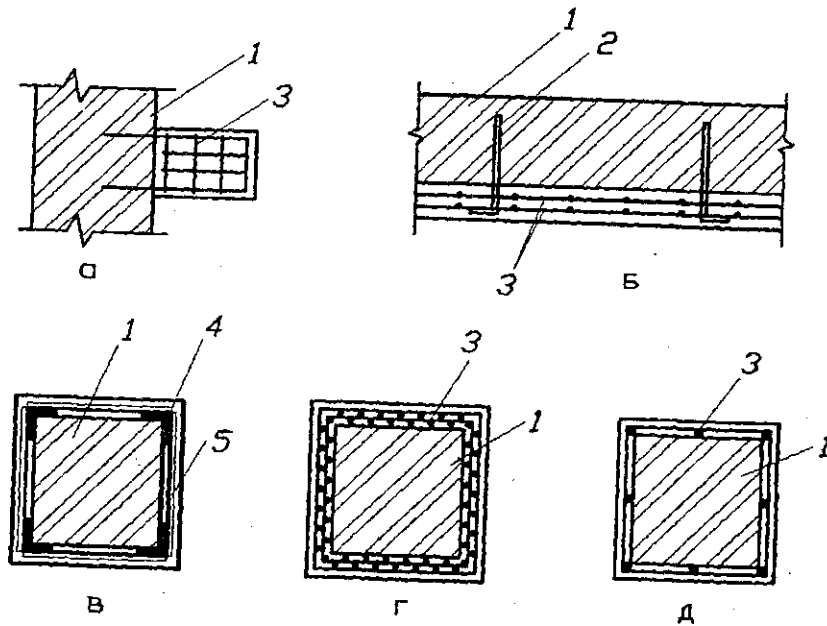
Усиление стен и столбов: а — армированной пилястрой; б — дополнительной железобетонной стенкой; в — обоймой из уголков; г, д — то же соответственно из армоцемента и железобетона; е — кирпичная кладка; ж — то же соответственно из армоцемента и железобетона; 1 — кирпичная кладка; 2 — анкер; 3 — арматурные сетки; 4 — уголок; 5 — полоса
